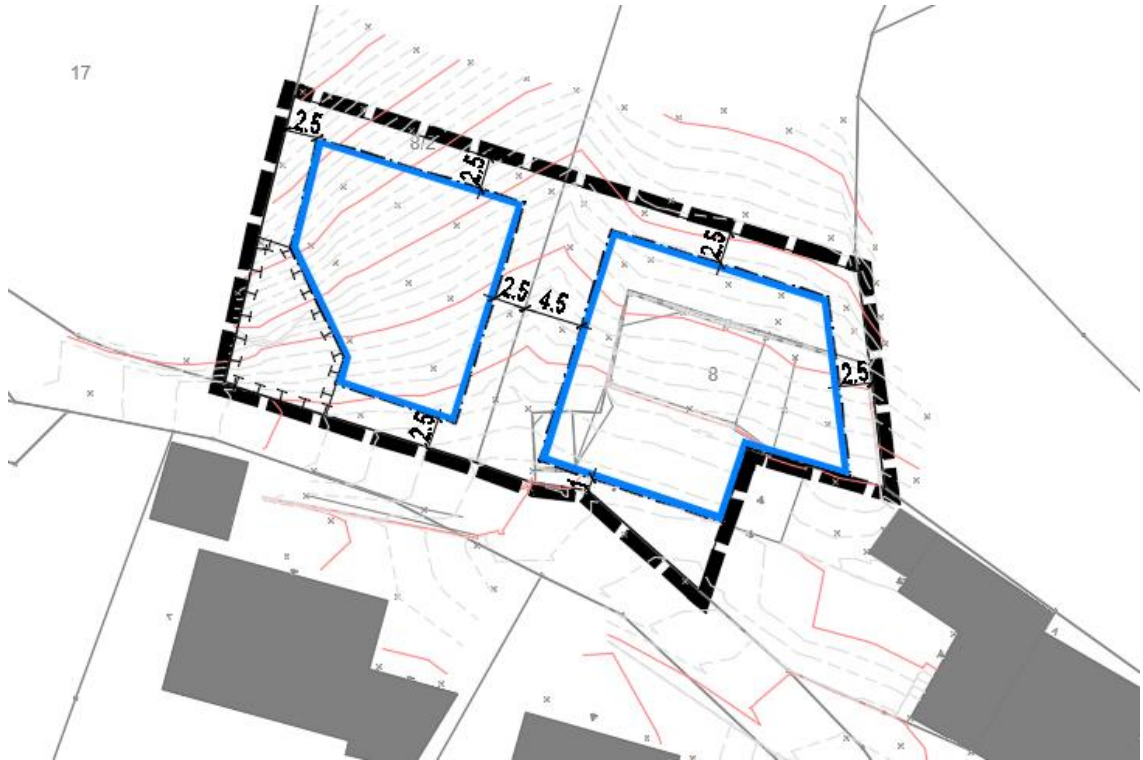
Geltungsbereich mit Baugrenze und Höhenvermessung
